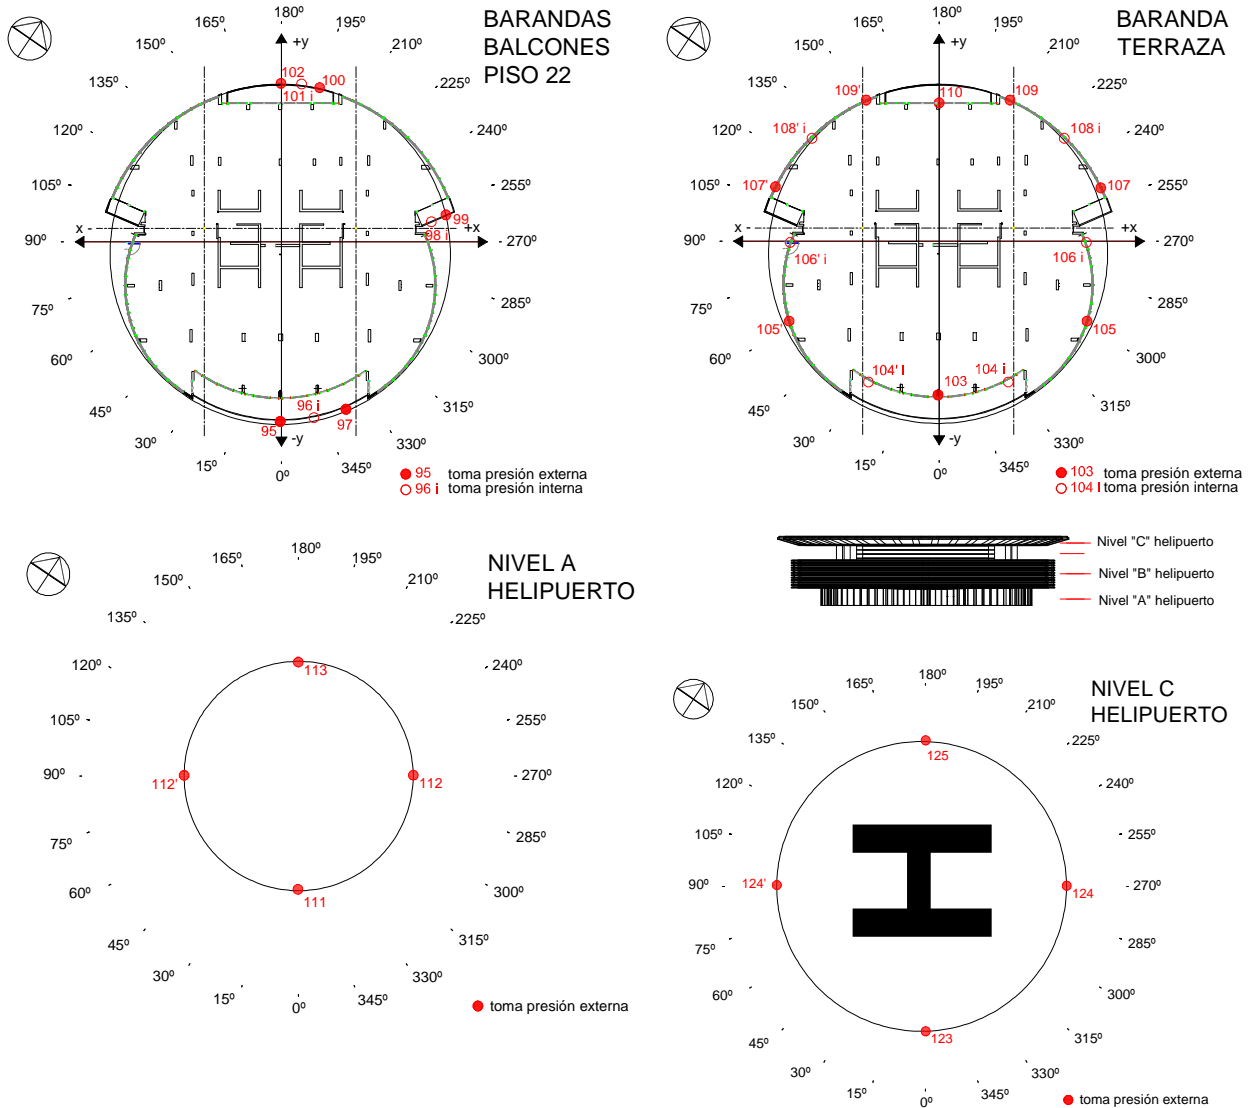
Ubicación en Planta de tomas de presión sobre elementos estructurales específicos.
